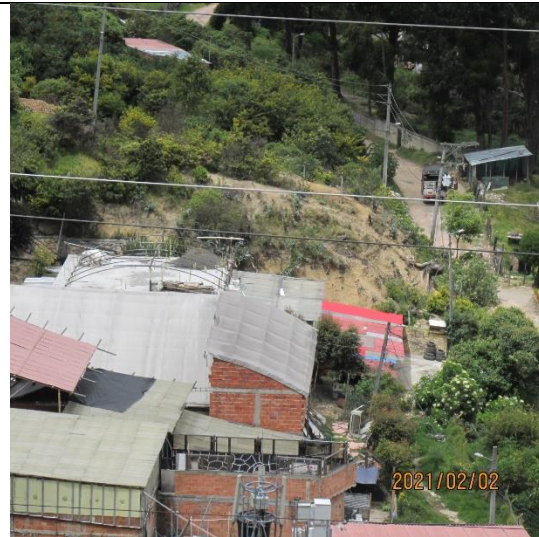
Vista al sur de la viviendas localizadas en la parte alta del sitio Bosque Calderón Tejada. Se aprecian estructuras de hasta 4 pisos de altura.
